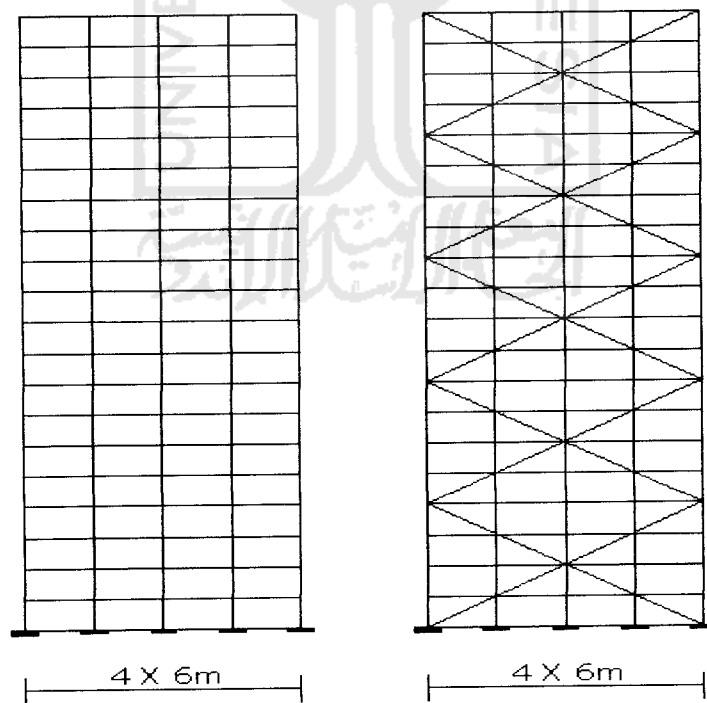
Potongan *Outrigger and Belt truss* 20 Lantai 2 *Outrigger
